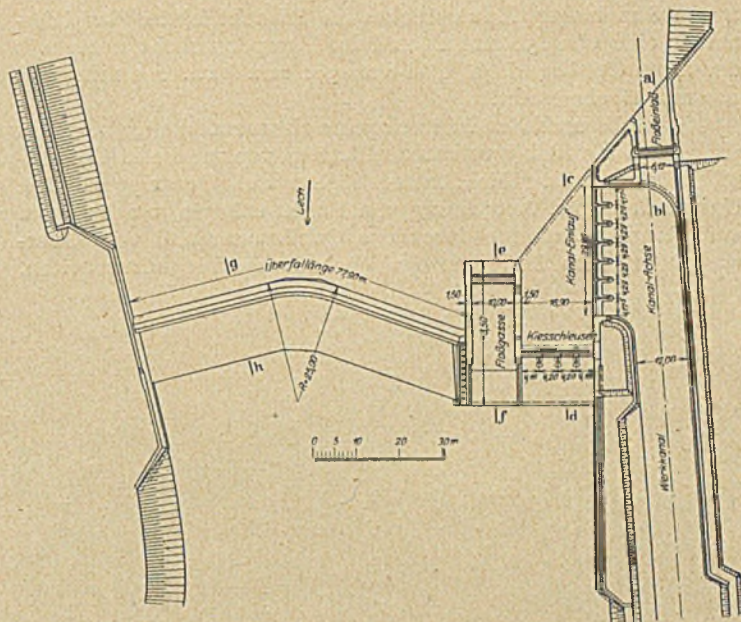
Grundriß der Wehranlage vor dem Umbau.
